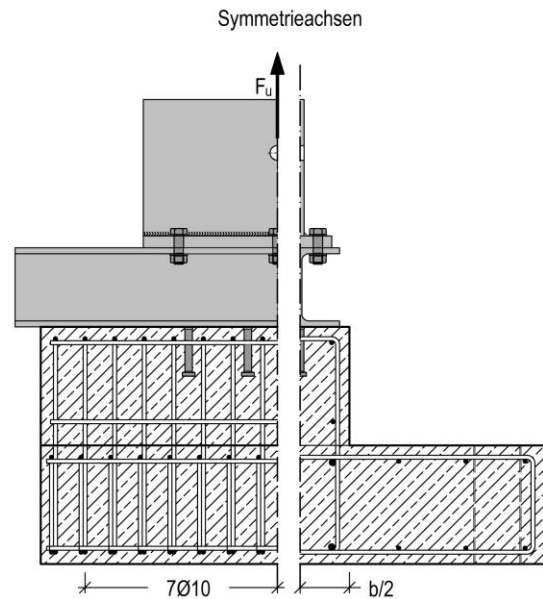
Schematischer Bewehrungsplan des Versuchskörpers R-02
